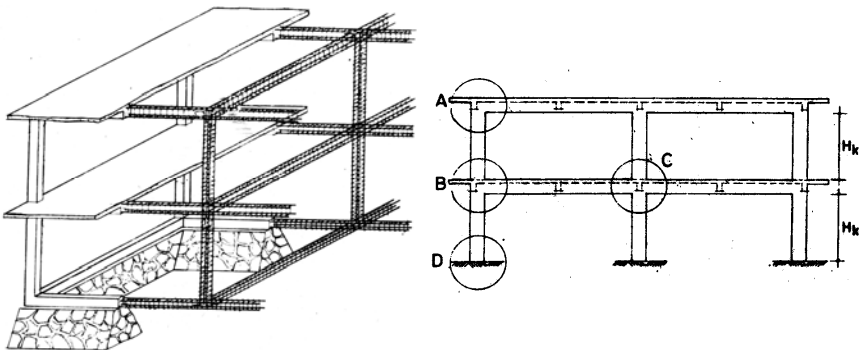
Detail penulangan pertemuan balok sloof dengan kolom
